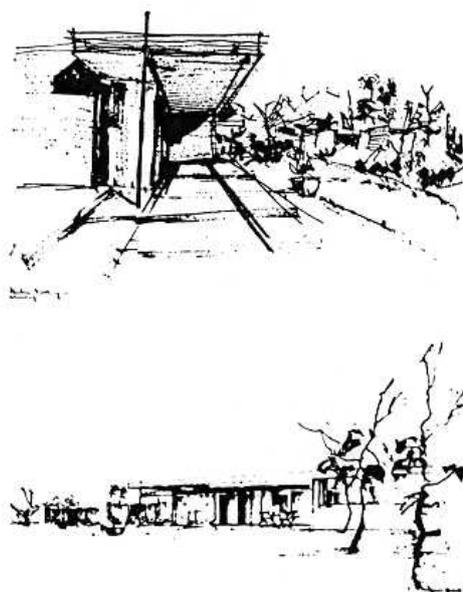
Proyecto casa tipo de las Colonias Bewobau.
